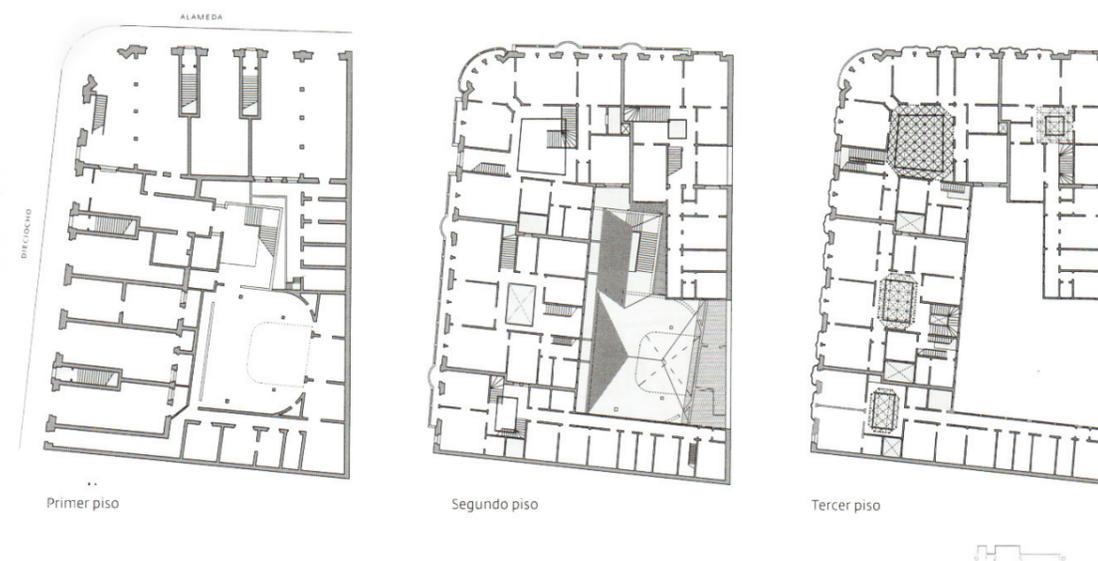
Plantas del Palacio Iñiguez (1908) proyectado por Ricardo Larraín Bravo y Alberto Cruz Montt. Se encuentra ubicado en Alameda esquina Dieciocho, Santiago. Fuente: Vizcaíno, M. (2010). Ricardo Larraín Bravo (1879-1945). *Obra arquitectónica*. Santiago: Ediciones Diego Portales.
